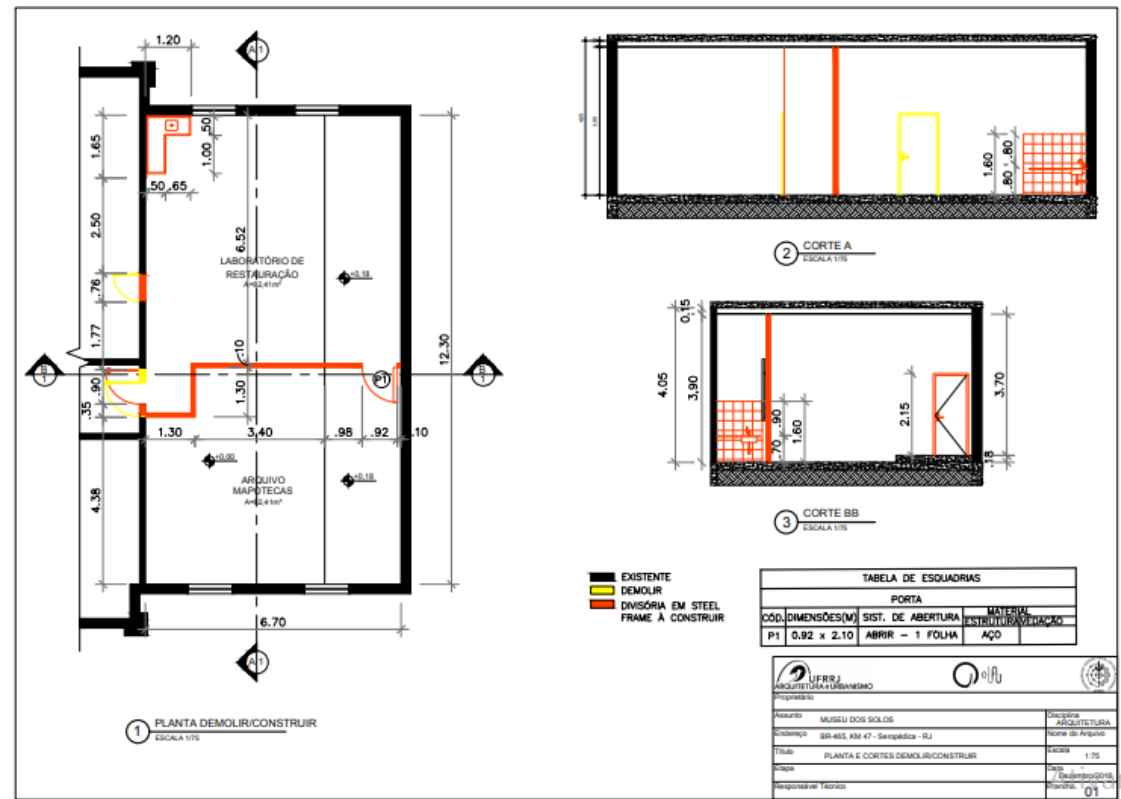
Planta de construir-demolir. Reforma para o LabDoc. Fonte: CARLOS, 2018.
